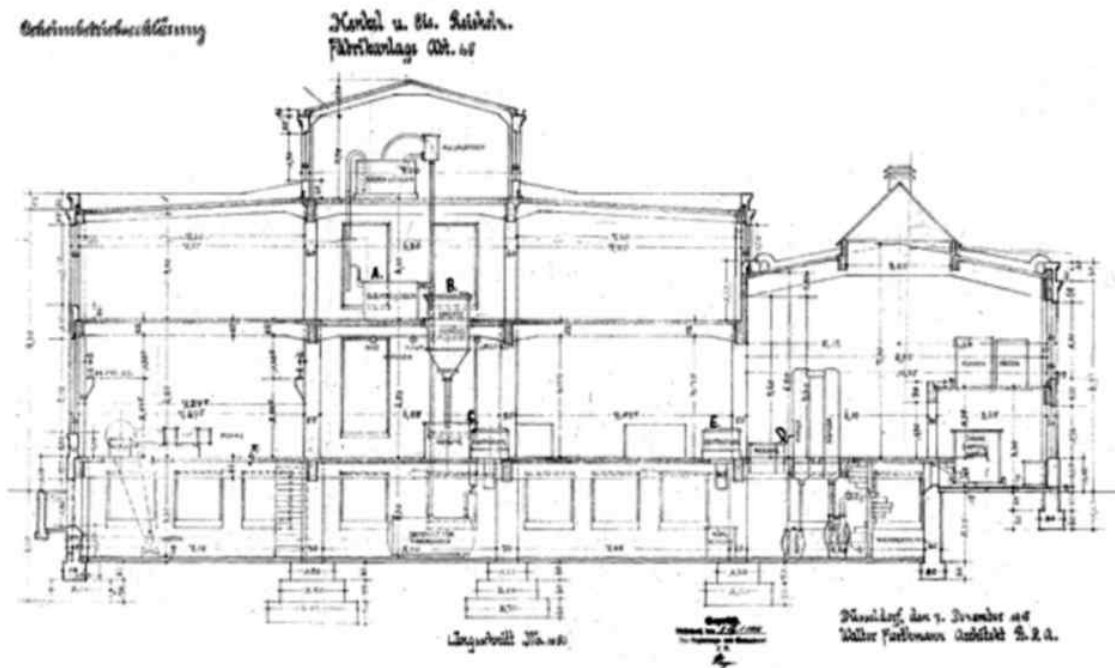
Errichtung Laugenfabrik Geb. F 05, 1917, Gebäudeschnitt mit Fabrikationsgang - Architekt: Walter Furthmann
